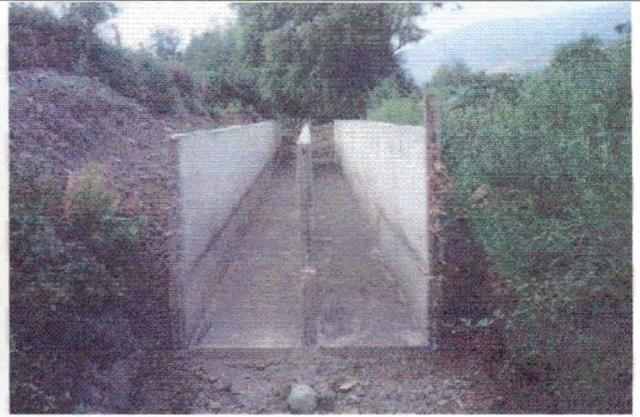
Desarenador. Estructura en construcción en sector de la bocatoma con fondos de la Ley N°18.450. Además se entubarán 250 m de canal.
